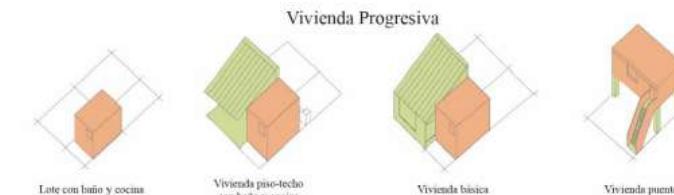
Tipologías de vivienda Solanda. Planificación original 1980.
